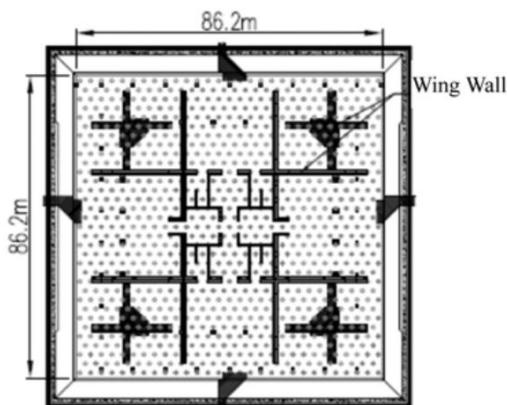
Свайно-плитный фундамент Голдин Файненс 117
